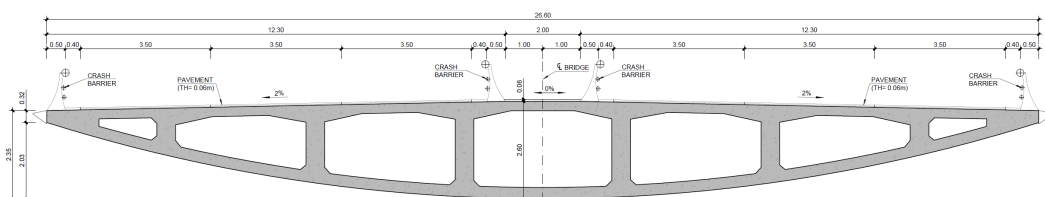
Sección transversal del tablero, un cajón multicelular de fondo curvo de radio constante.
